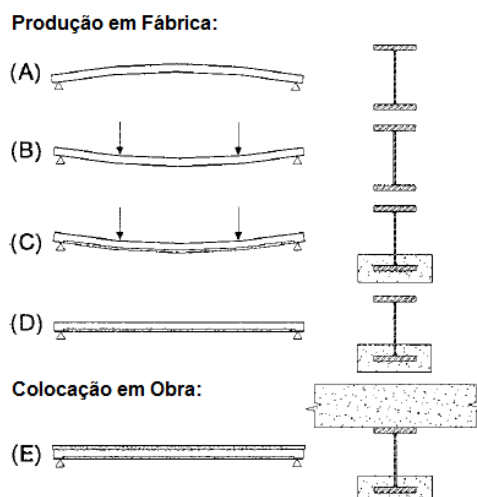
Fases construtivas de vigas pré-flectidas: (A) montagem da viga de aço; (B) pré-flexão da viga de aço; (C) betonagem do banzo de betão; (D) libertação da viga; (E) colocação da laje de tabuleiro (Morano, S.G. *et al* 2006).
